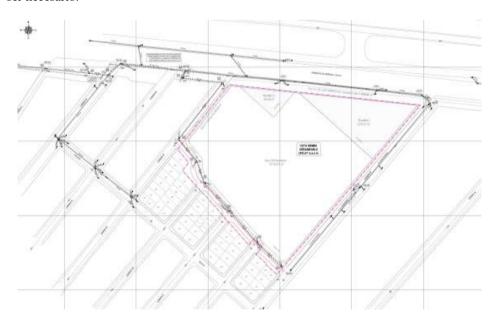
Red de Alcantarillado Pluvial, Plan Parcial Cartón Colombia Fuente. Esta Consultoría
